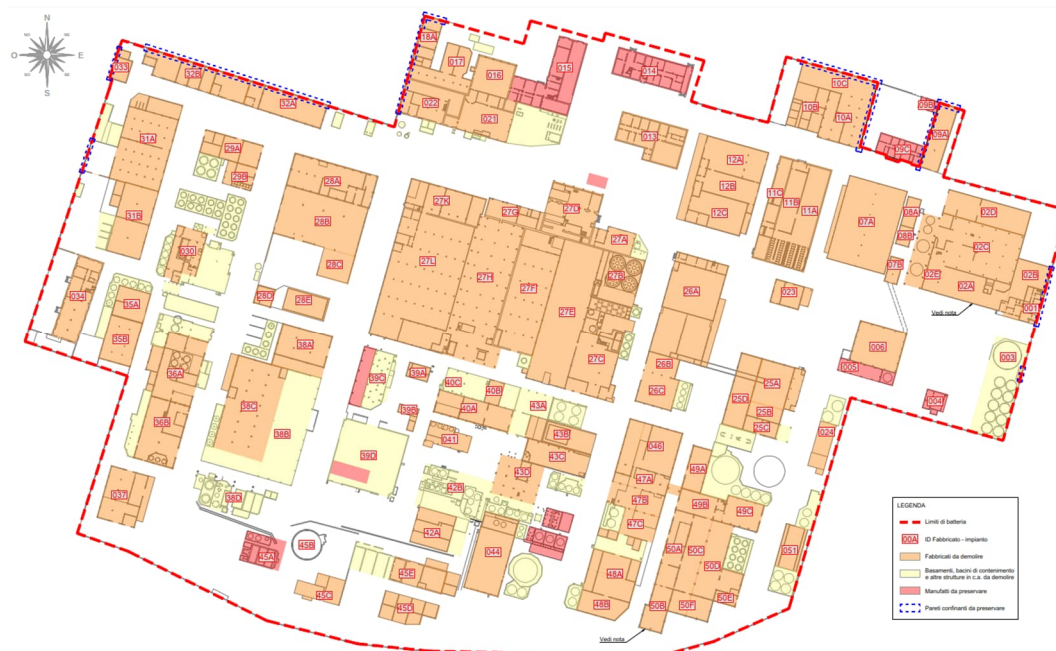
Planimetria dei fabbricati oggetto di intervento (estratto D-011-23634793-WP.0-EN-DIS)
